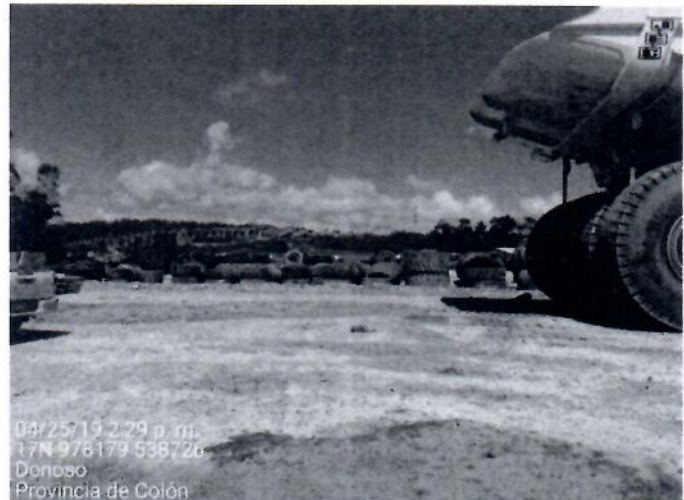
Se evidencia agua estancada en el área de la Planta de Concreto de Botija.
